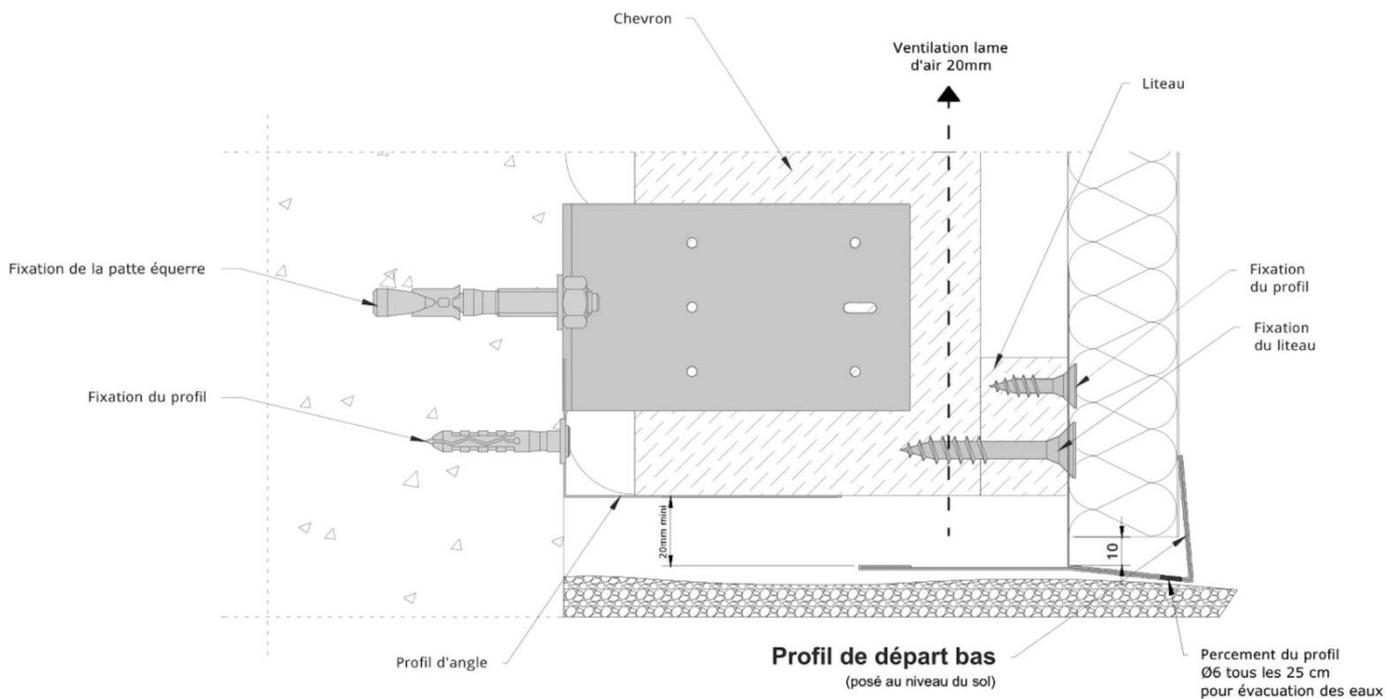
Bas de façade – Pose en vêtire (coupe verticale)
